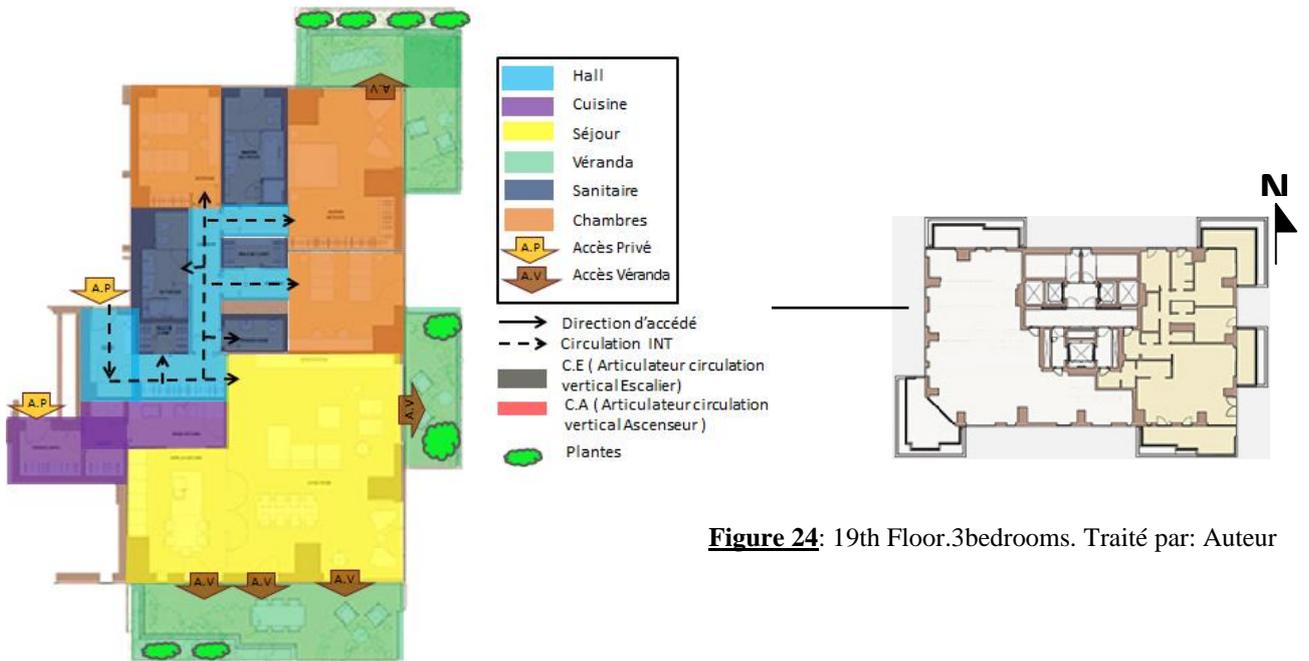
19th Floor. 3 bedrooms. Traité par: Auteur
